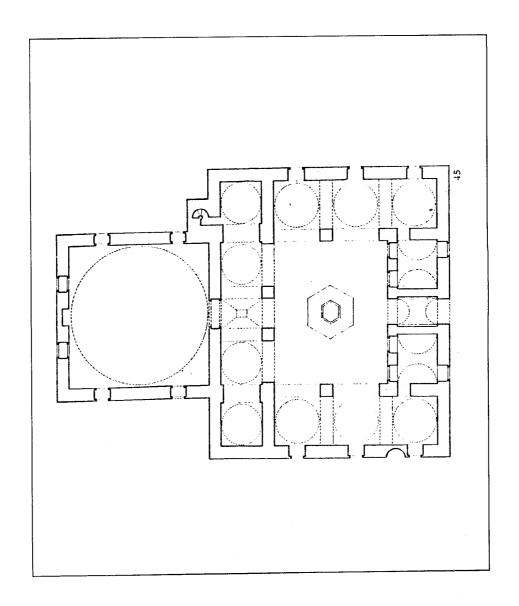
مسقط أفقي لمسجد شريف خليل باشا المعروف بمسجد تومبول في بلغاريا (عن : كيل) .
